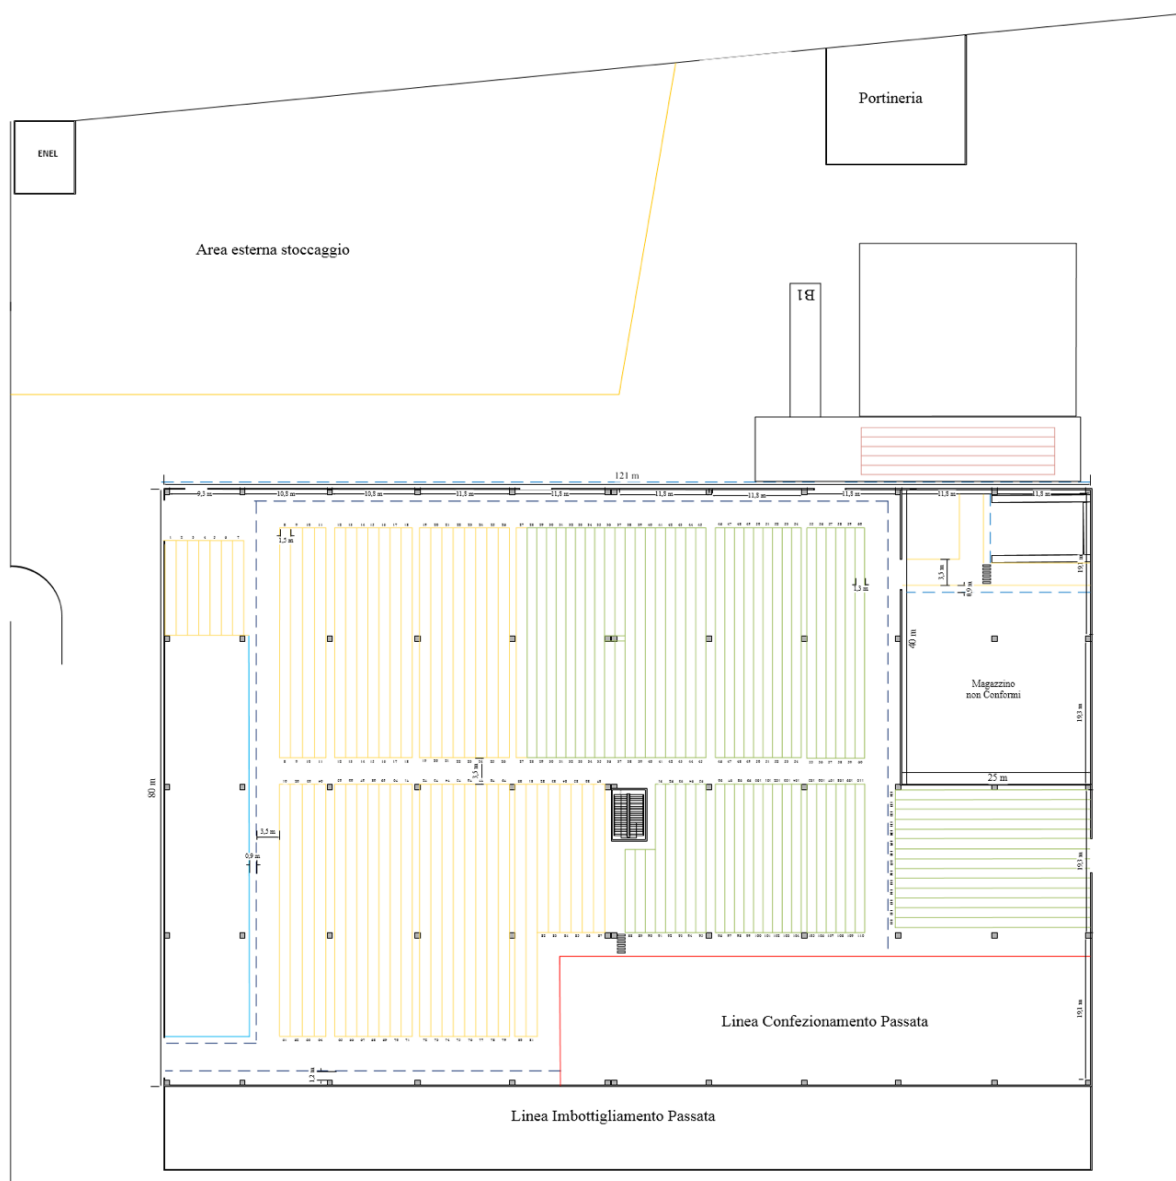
Layout Magazzino Lotto 10 con baia di carico
